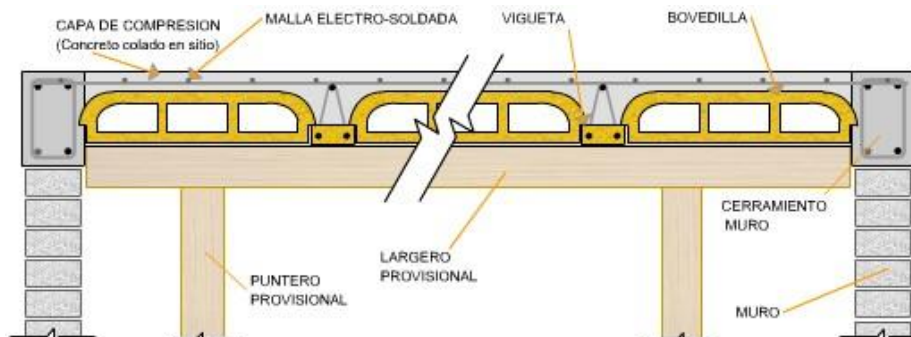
Detalle general del sistema de vigueta y bovedilla.
